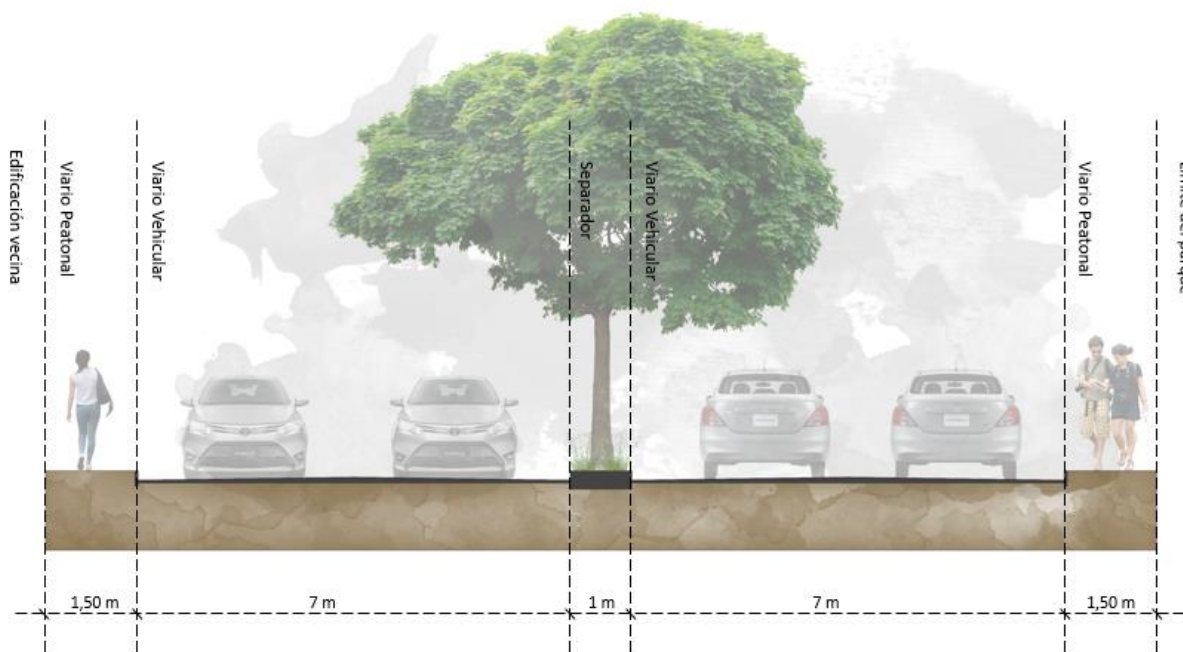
Perfil vial de la calle 45, Barrio Campo Hermoso .
